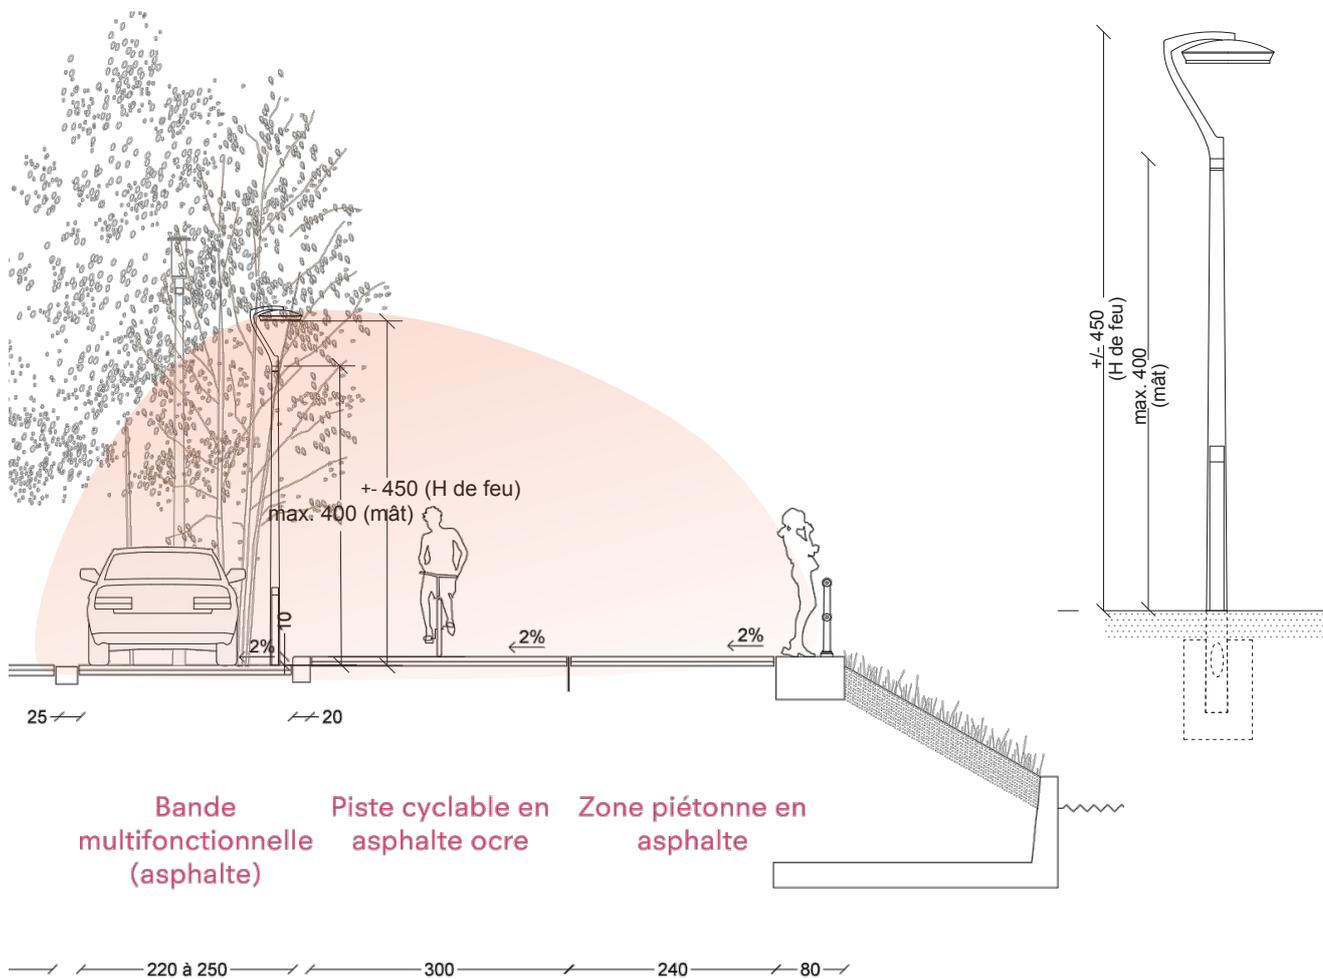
Coupe et plan type d'éclairage des quais en secteur Centre
